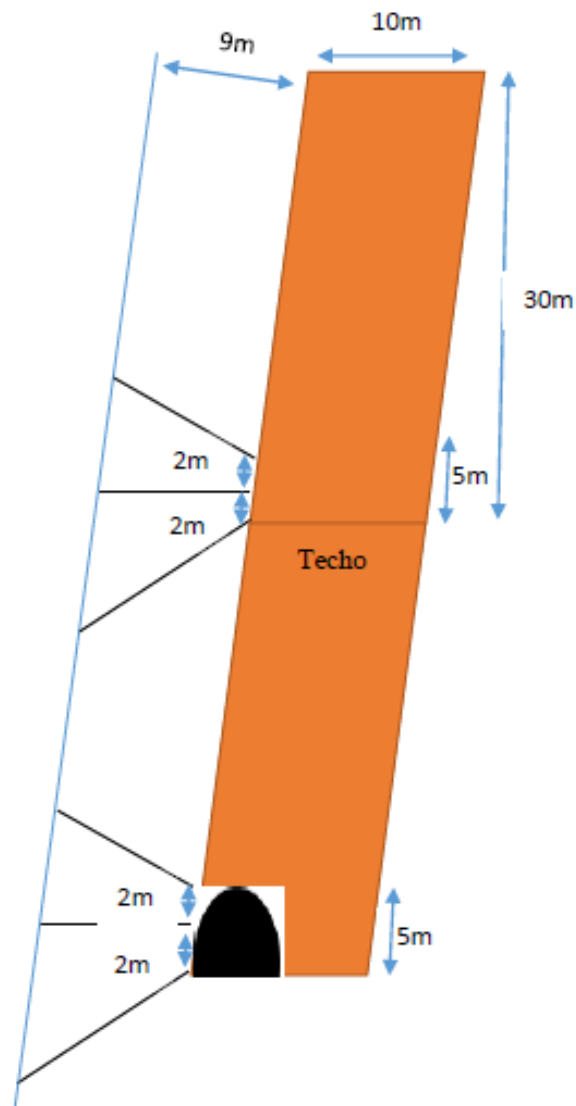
Propuesta de sostenimiento con cables de anclajes sencillos para el *hangingwall* en la cámara a 450m.
